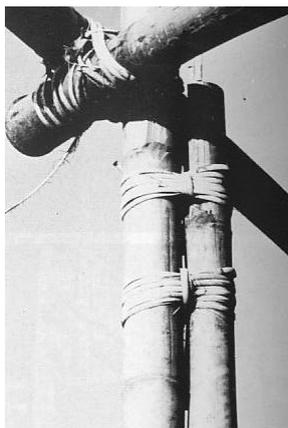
Detalhe das amarrações de uma estrutura vernacular de paredes e vigas
